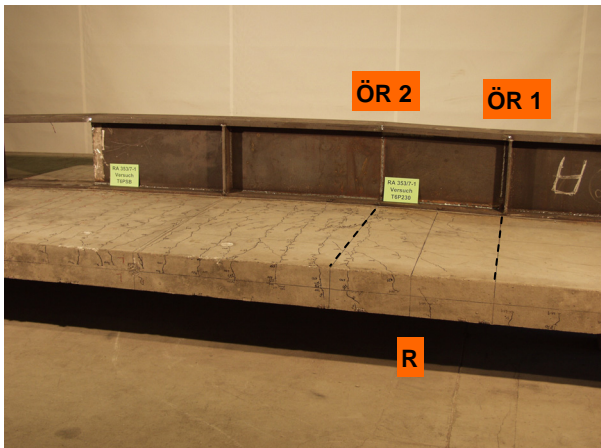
Rissbild auf der rechten Betongurtseite
